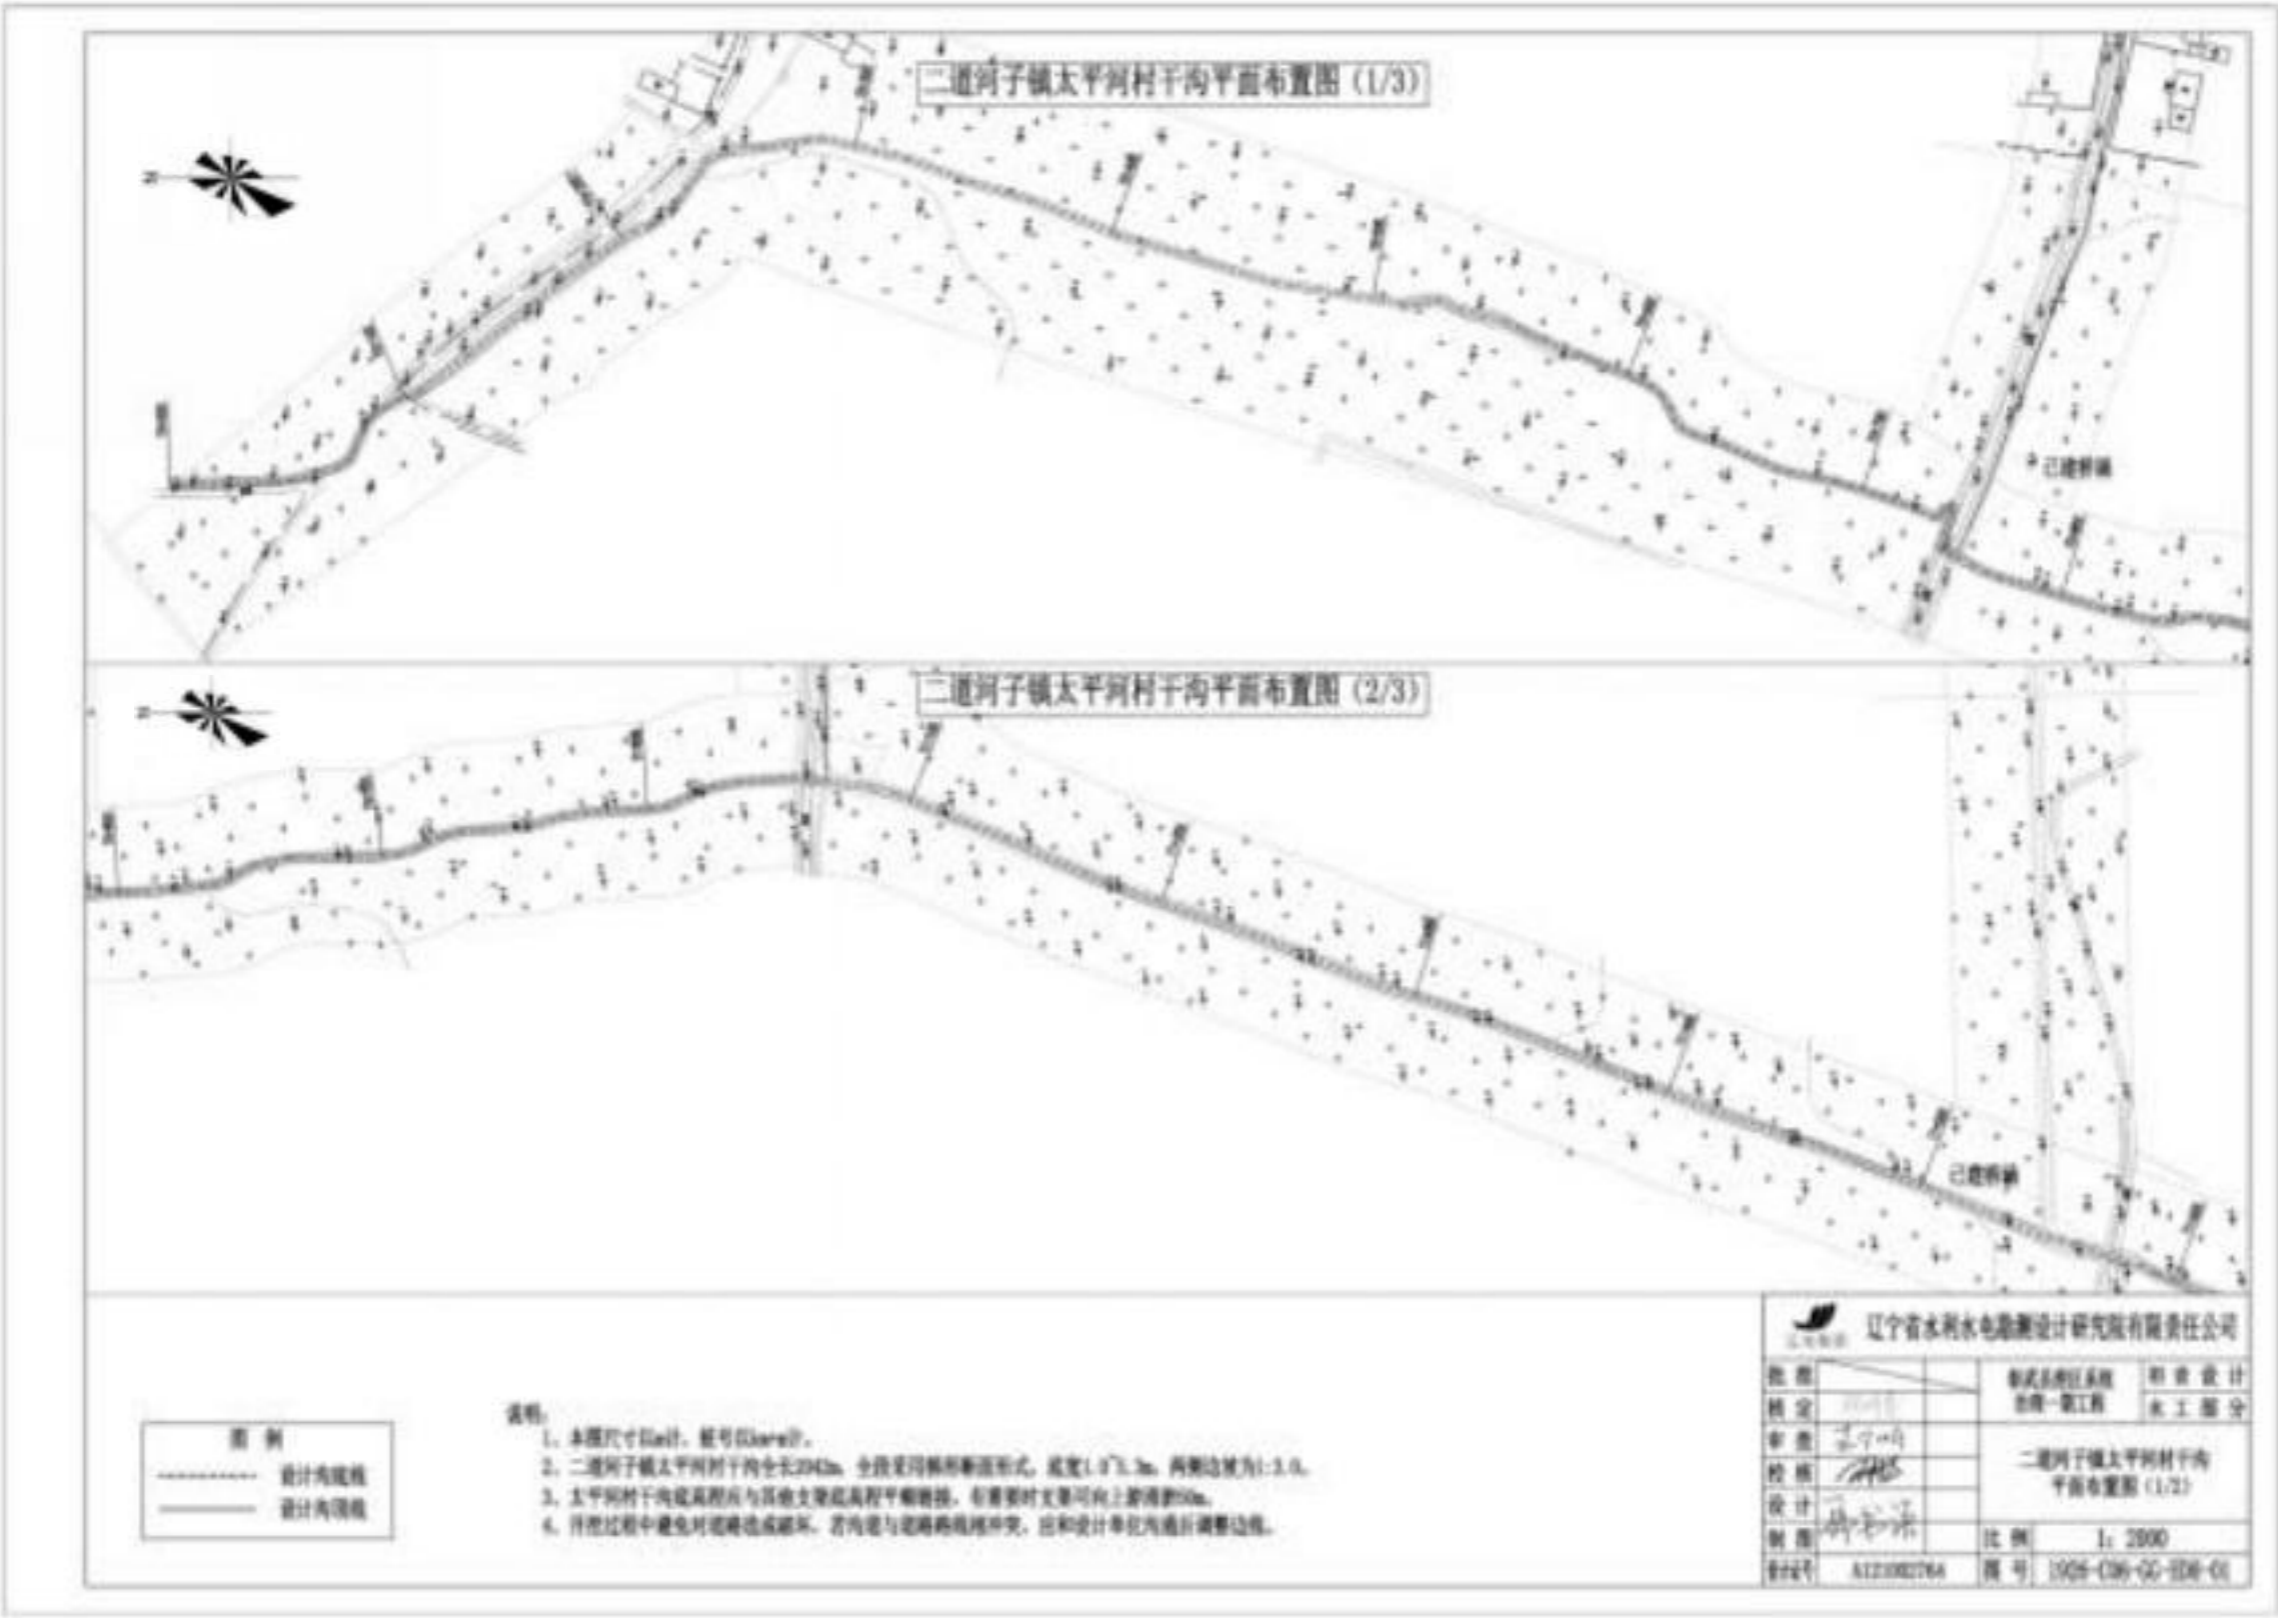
(1) 二道河子乡太平河村干沟平面布置图
